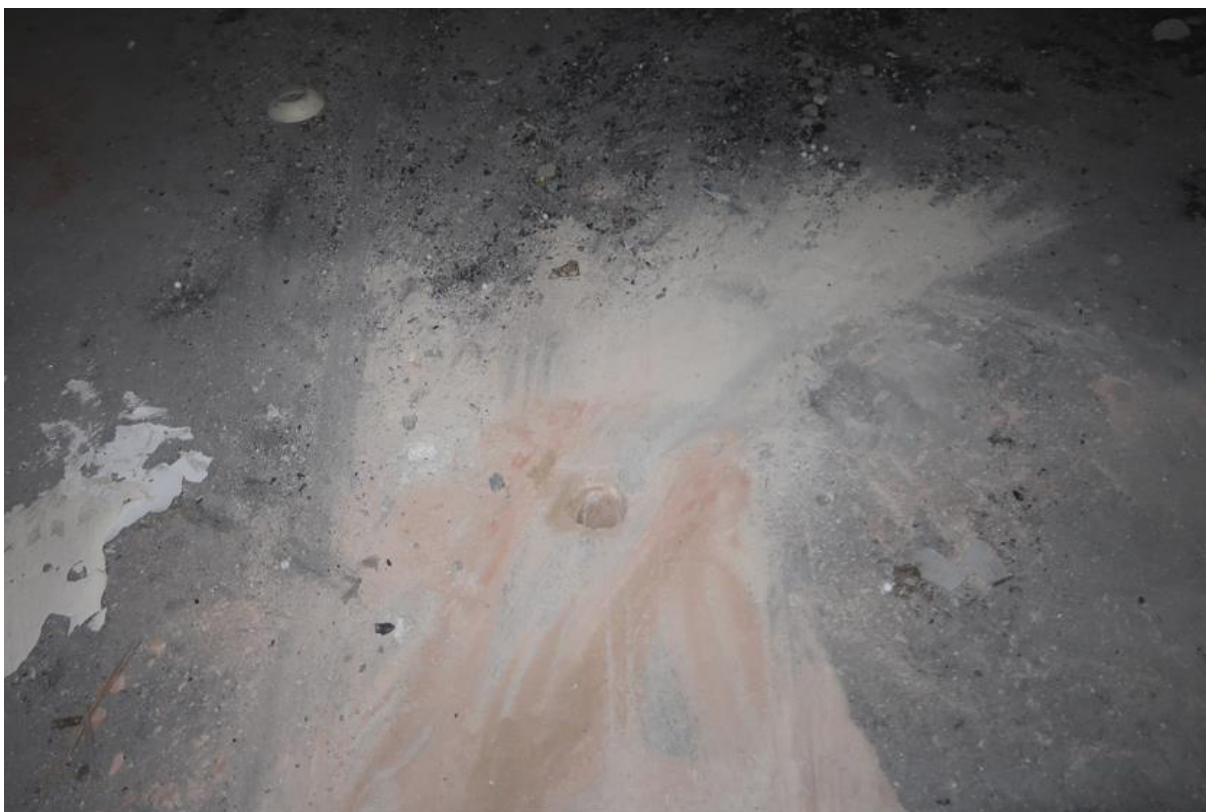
Odkrywka O.7 posadzki. Stwierdzono posadzkę betonową gr. ok. 20cm z lastryko wykonaną na warstwie gruzobetonu leżącego na stropie nad piwnicą.
